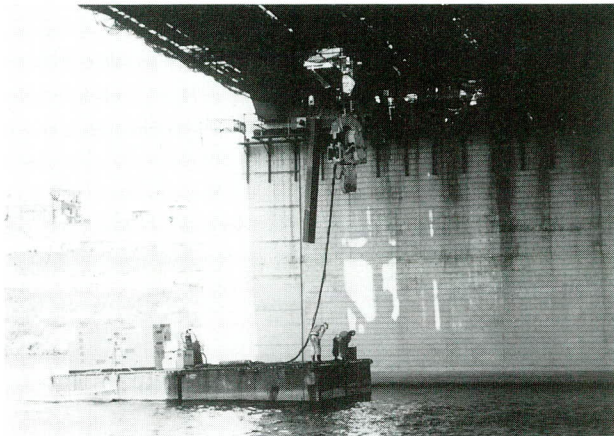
ベント設備 基礎杭の引抜き（橋上より）
